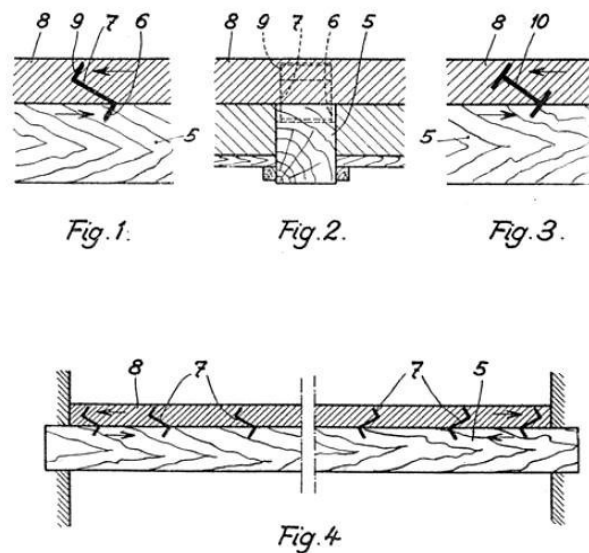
Verbunddecke aus Holzrippen und Betonplatte nach Schaub [35]
